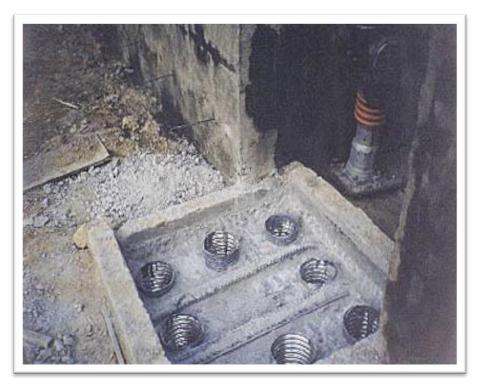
Dado de conexión ya colado. Proyecto: estacionamiento Anáhuac.
